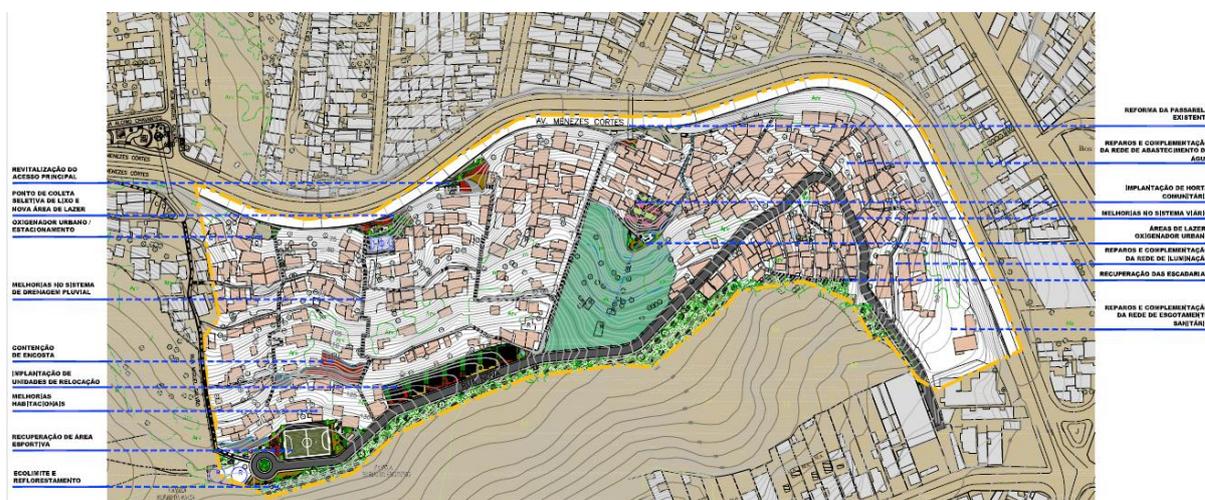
PAC2: Plano de Intervenções do Morro do Encontro
